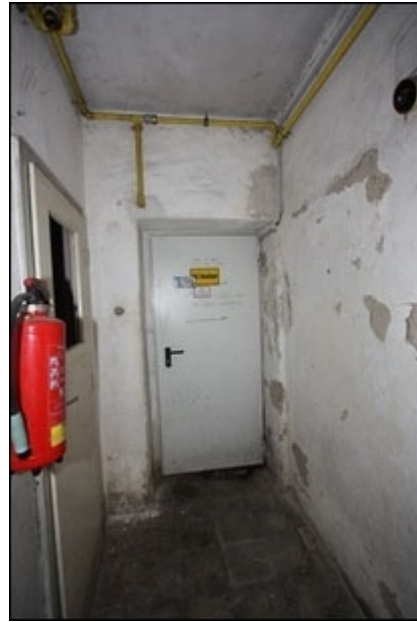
Ansicht Stiegenhaus KG, Zugang KG West
